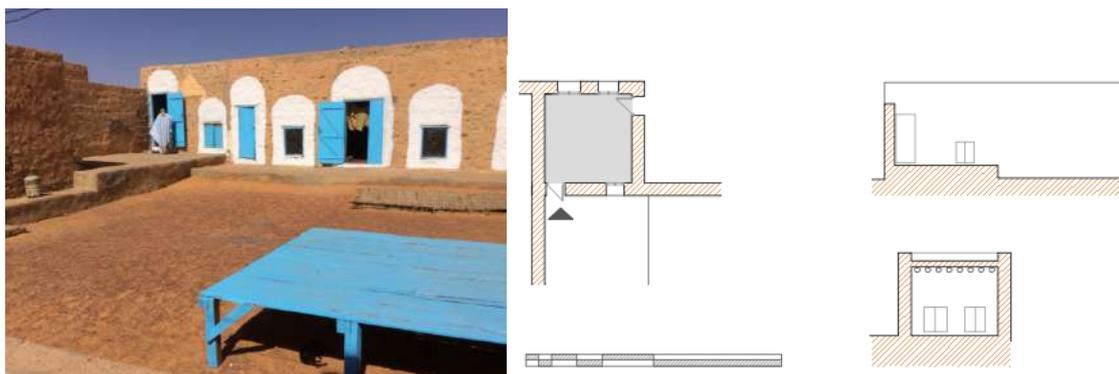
Pormenor do pátio da Biblioteca Hanchi e o levantamento arquitetônico da mesma. (Terrachidia)
